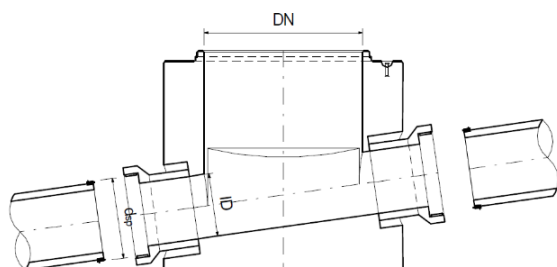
Anschluss mit Steinzeugrohre Typ N mit Gefälle J ≤ 500 ‰
